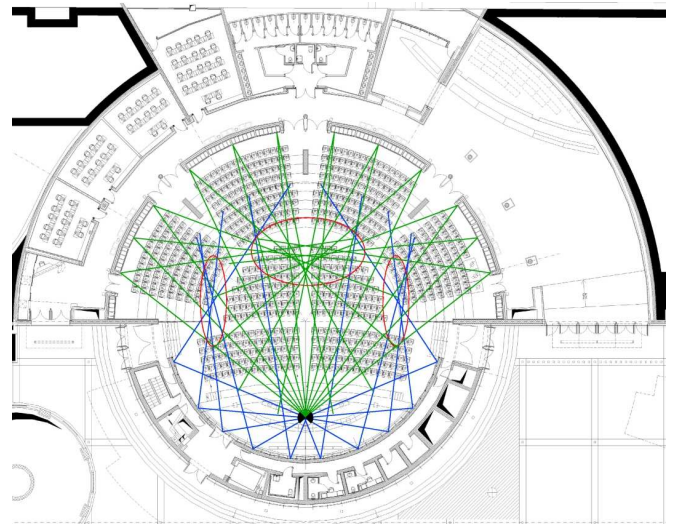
Kreisförmiger Grundriss mit Brennpunktbildung (markiert mit Ellipsen)
